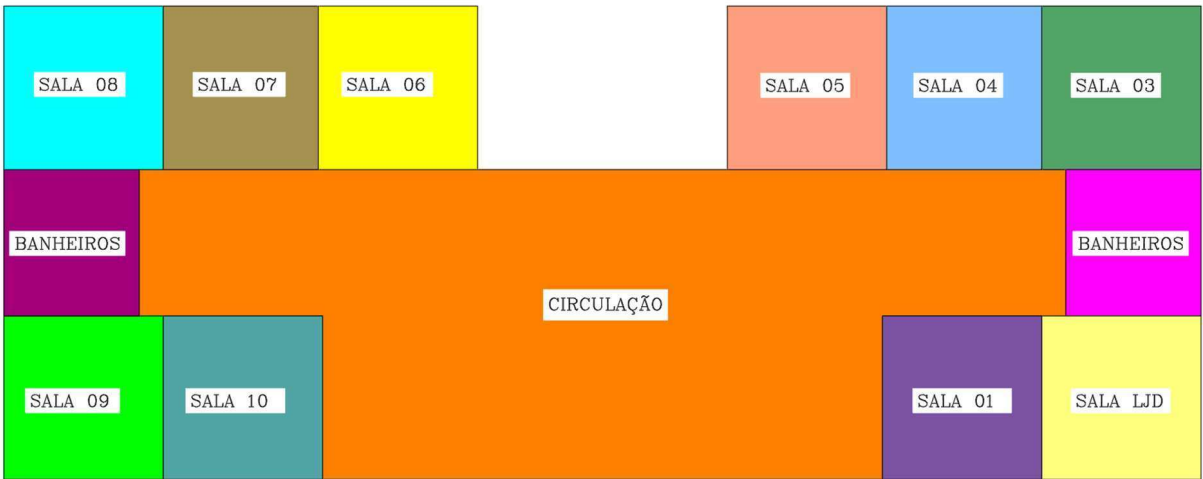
Planta baixa com as Zonas Térmicas do 1º Pavimento.
